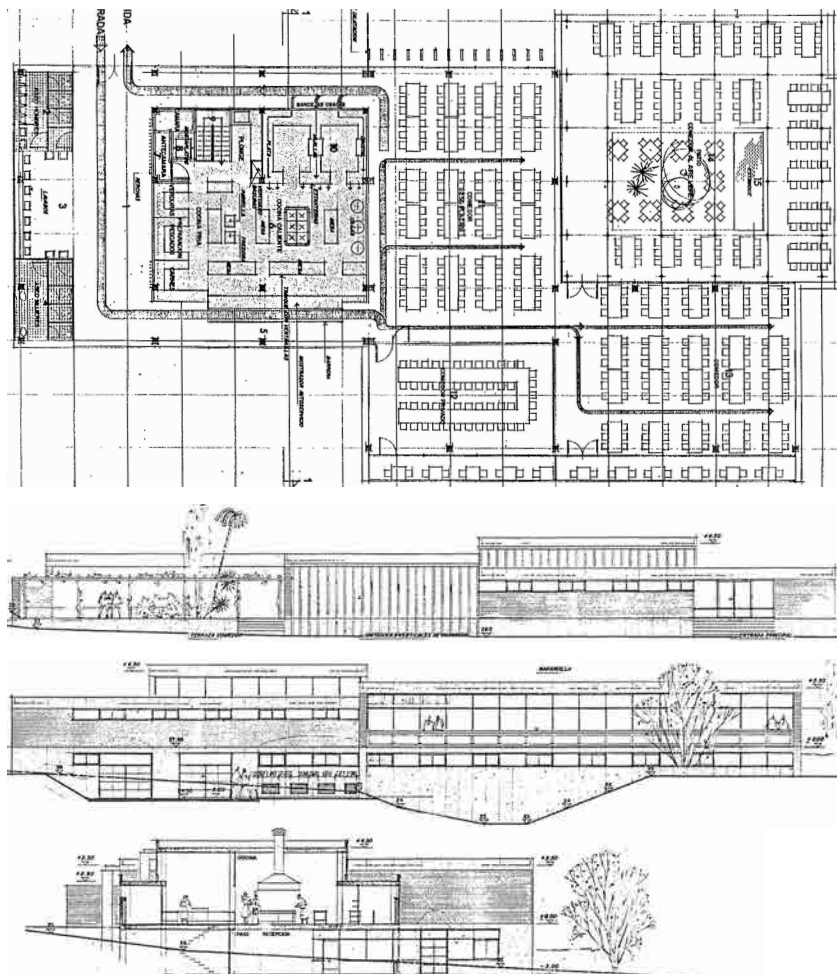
, Fig. 47, Fig. 48 y Fig. 49 Edificio de comedores-cocinas y servicios. De arriba a abajo: planta superior o principal, alzado de la fachada Norte o de acceso, alzado de la fachada Sur o posterior, y sección transversal.
